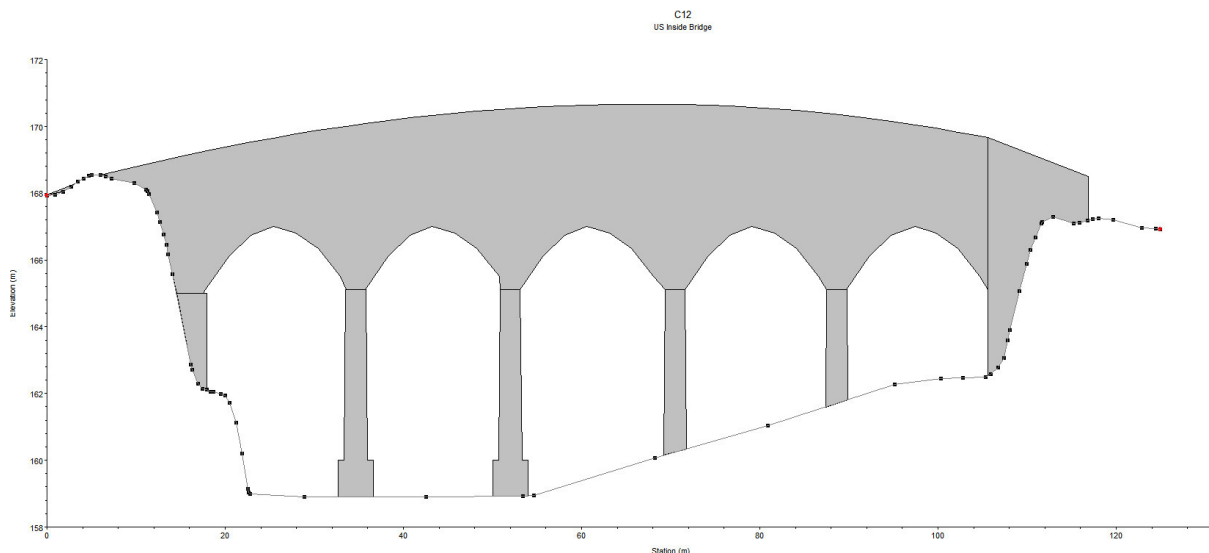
Ouvrage hydraulique de type pont (Pont de Urçay)
